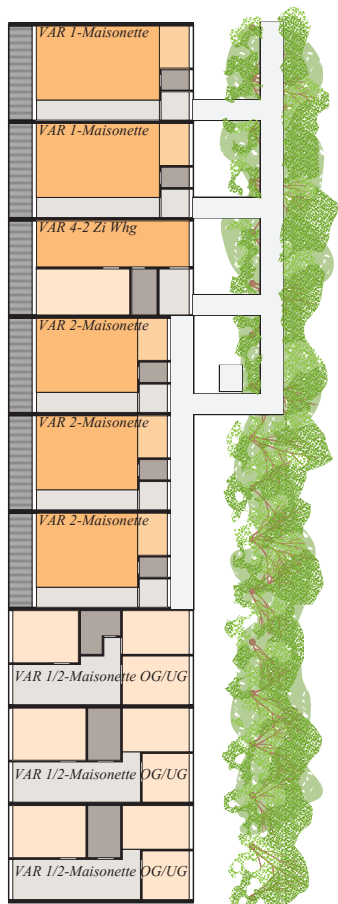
Exemplarischer Grundriss Laubengangtypus
